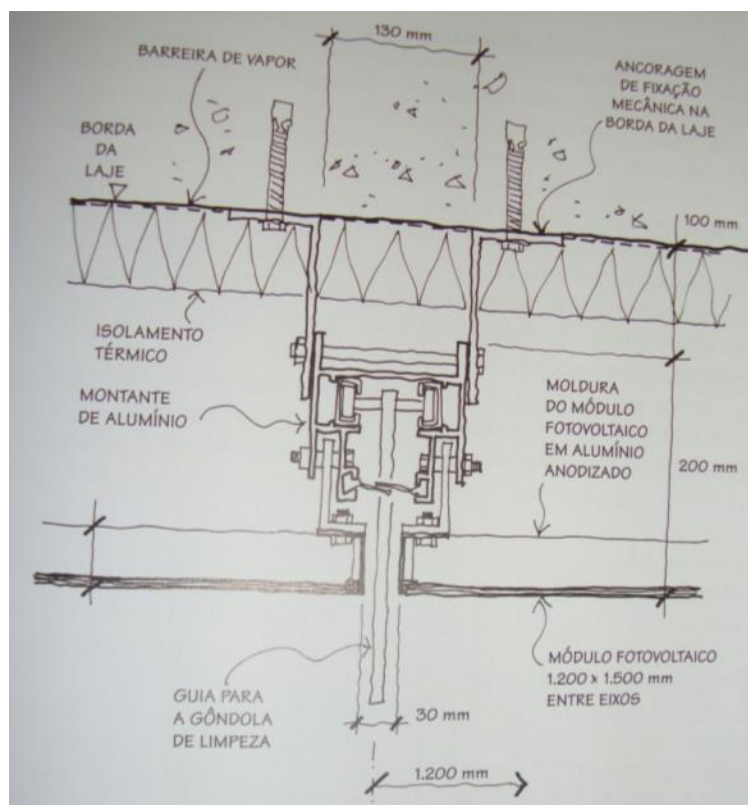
Exemplo de detalhe em planta baixa da fixação dos módulos sobre a estrutura em uma parede ventilada.
